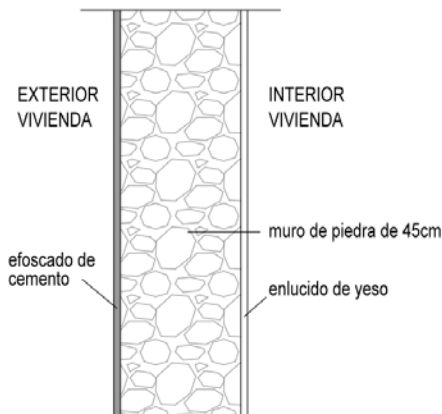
Muro de piedra existe en la vivienda. Fuente propia.
